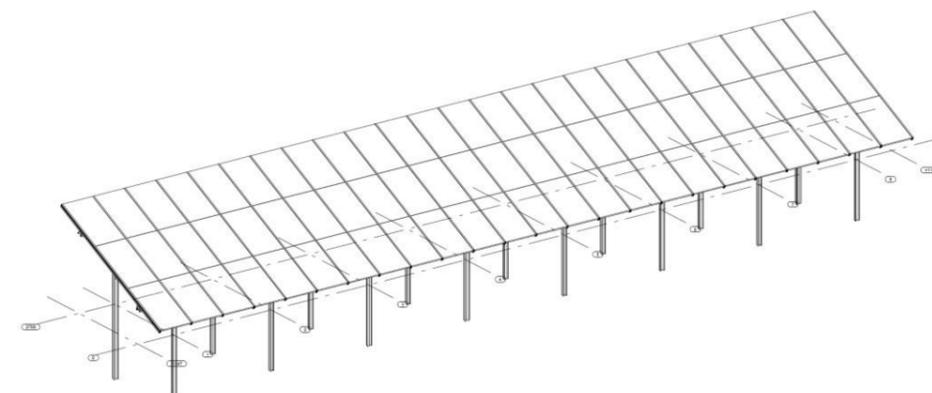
Exemple du type de fondation et d'ancrage par pieux battus
